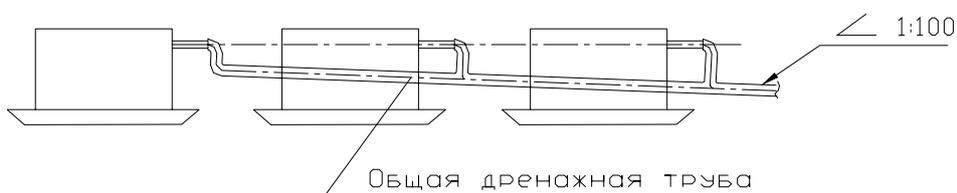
дренажный трубопровод с общей дренажной трубой
